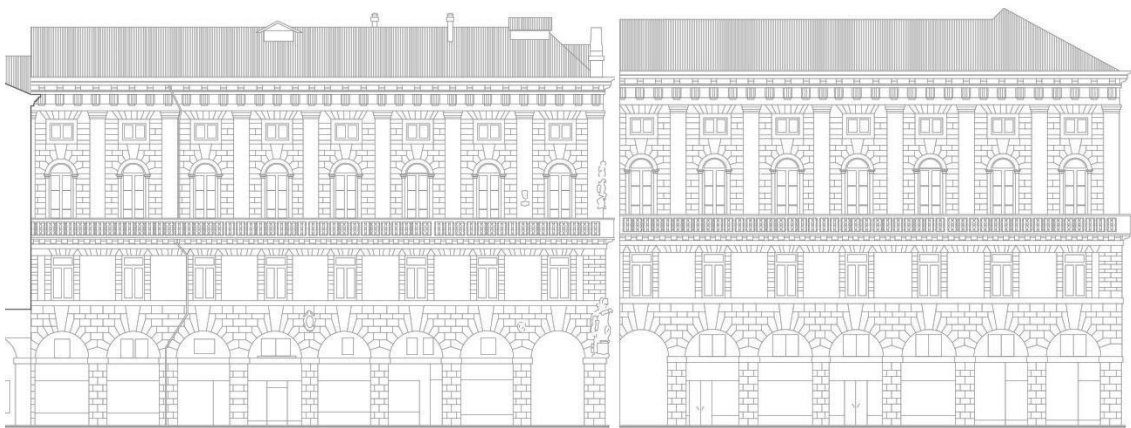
prospetti ovest su Piazza delle Erbe.
